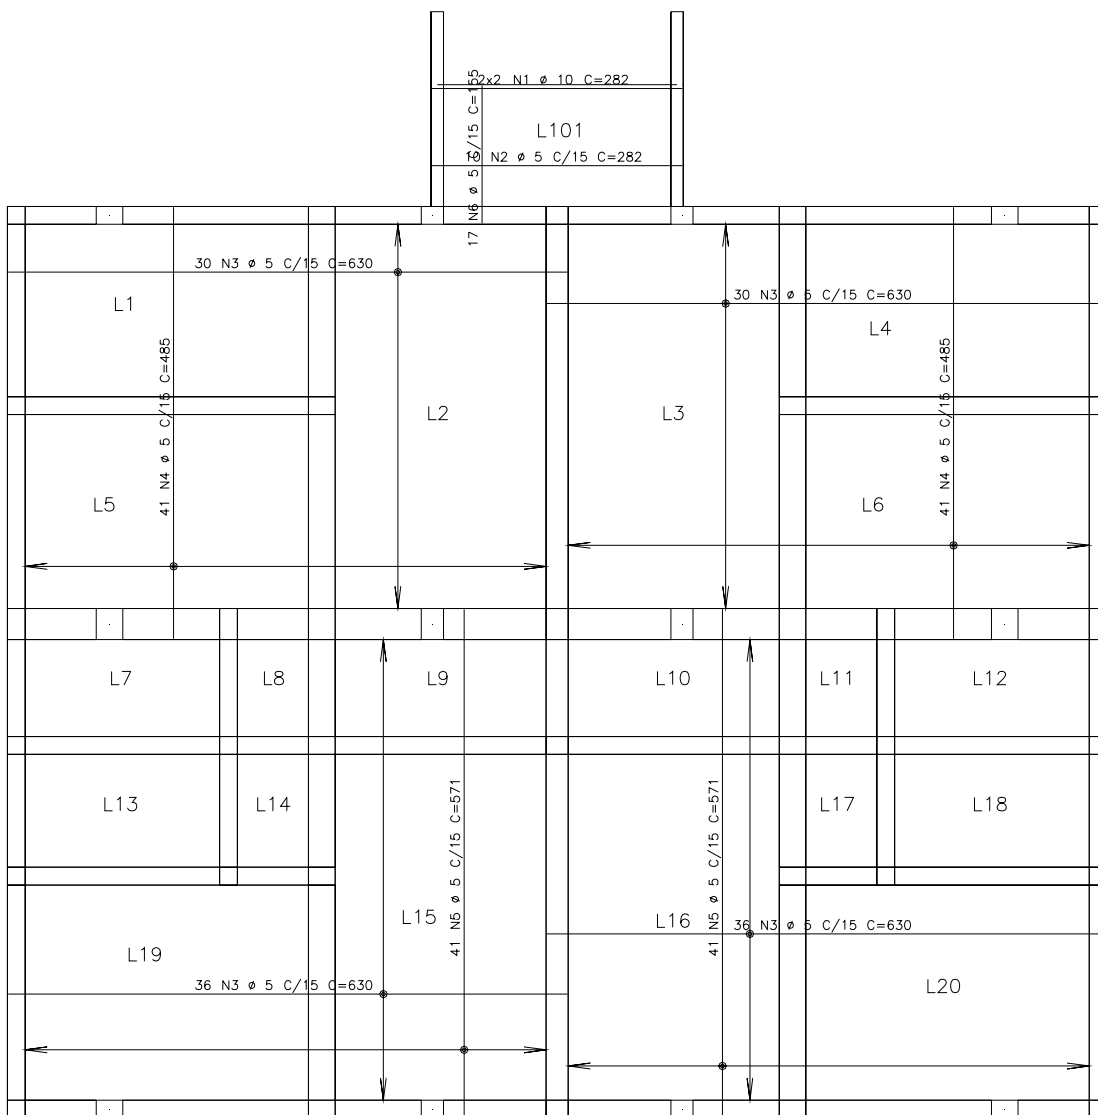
Prédio “C” – Opção 1 – Armação positiva das lajes
